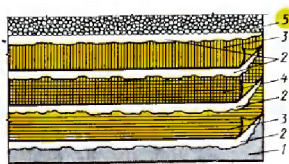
Стеклорубероидная кровля на мастике БПАМ:
